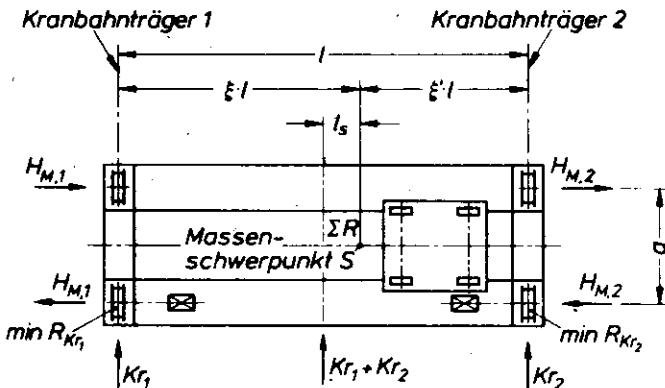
Horizontallasten H_M für Laufkran EFF beim Anfahren mit Katze in äußerster Stellung
